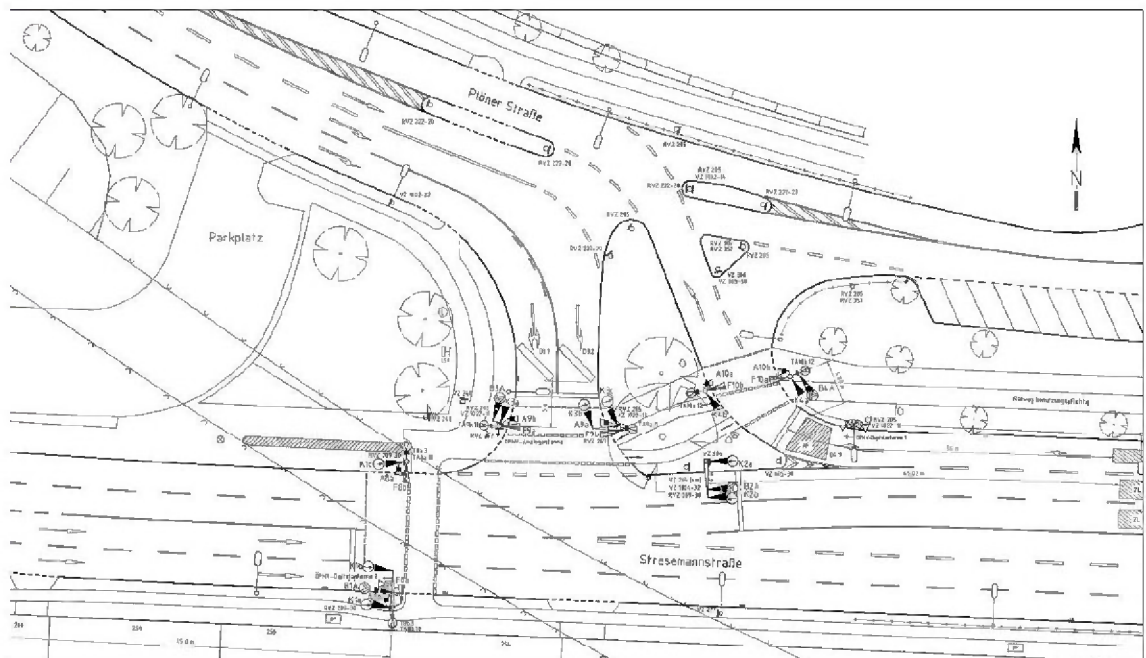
Signallageplan Stresemannstraße/Plöner Straße – Bestand (14/1568-04-04/02)
